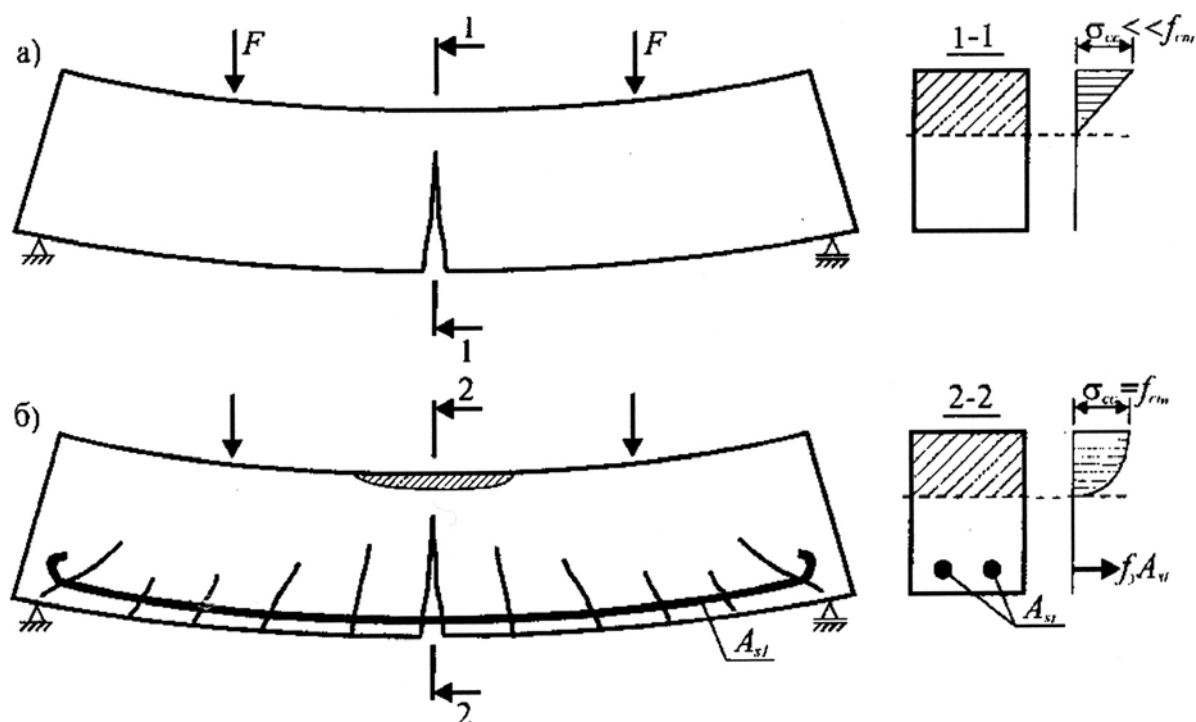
Характер образования трещин и разрушения бетонной (а) и железобетонной (б) изгибаемых балок
